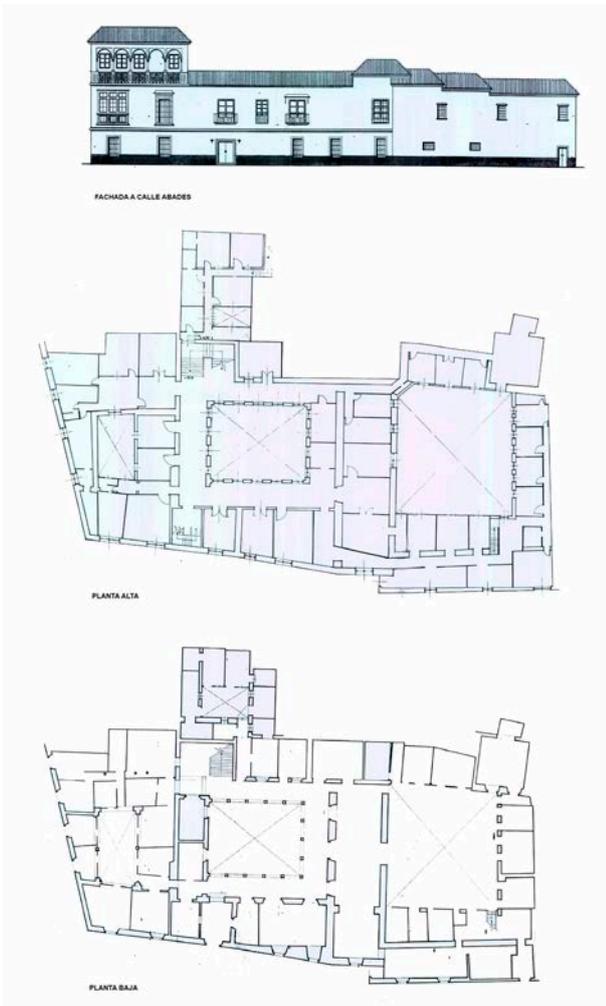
Jesús Gómez-Millán. Fachada, planta alta y planta baja. 1964. FIDAS/COAS.
